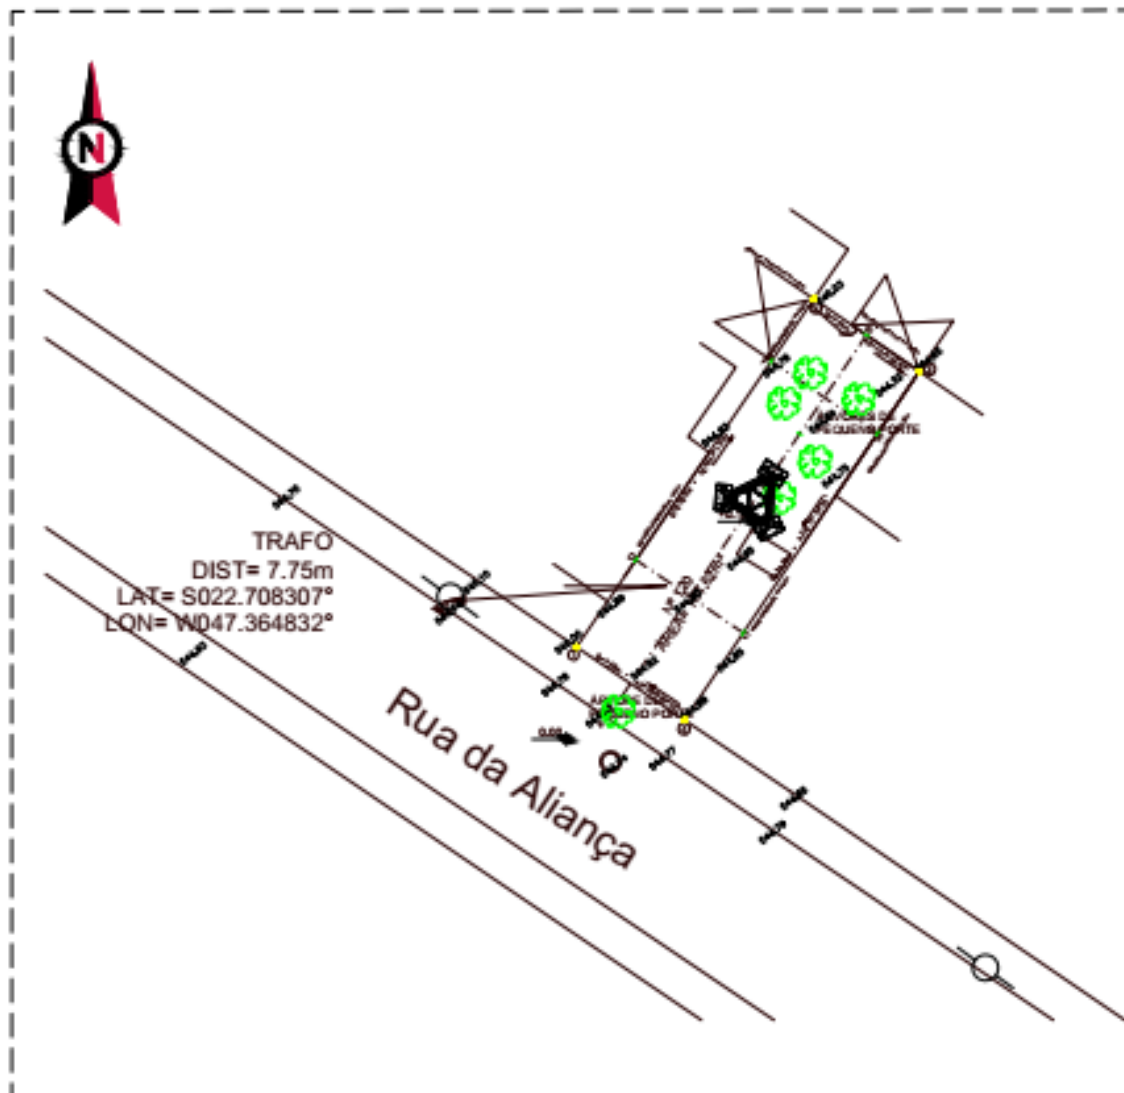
Situação do terreno – Planta Planialtimétrica – Fonte: Projeto Arquitetônico
